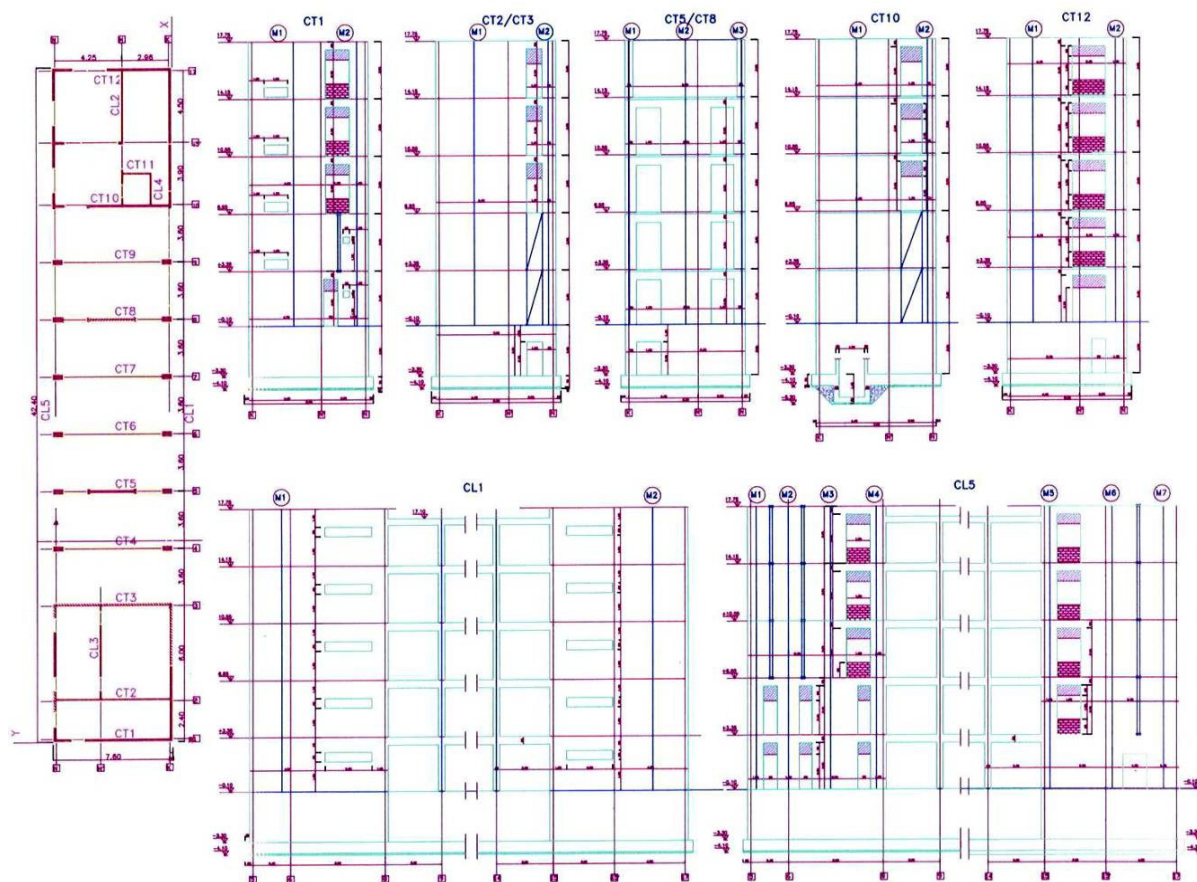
Tronson A2 : Sistem structural în plan; Elevațiile pereților structurali [11].
